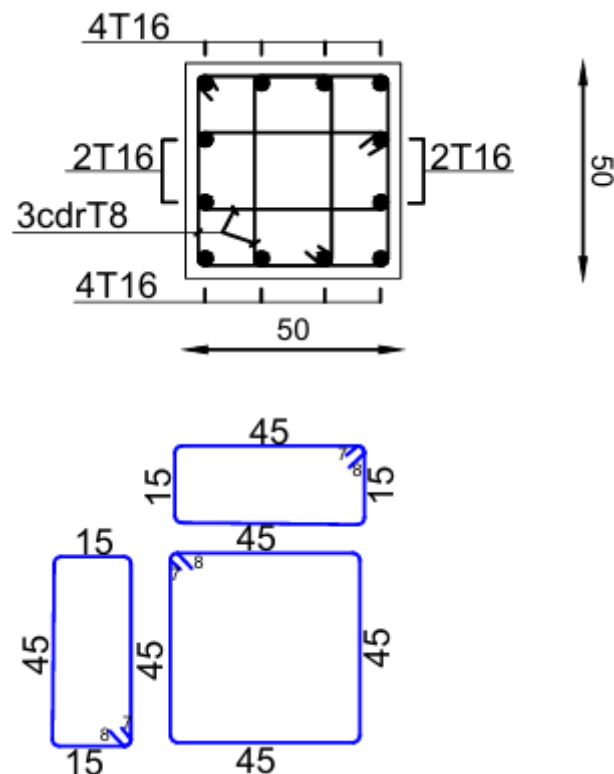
Schéma de ferrailage de poteau (50*50).
